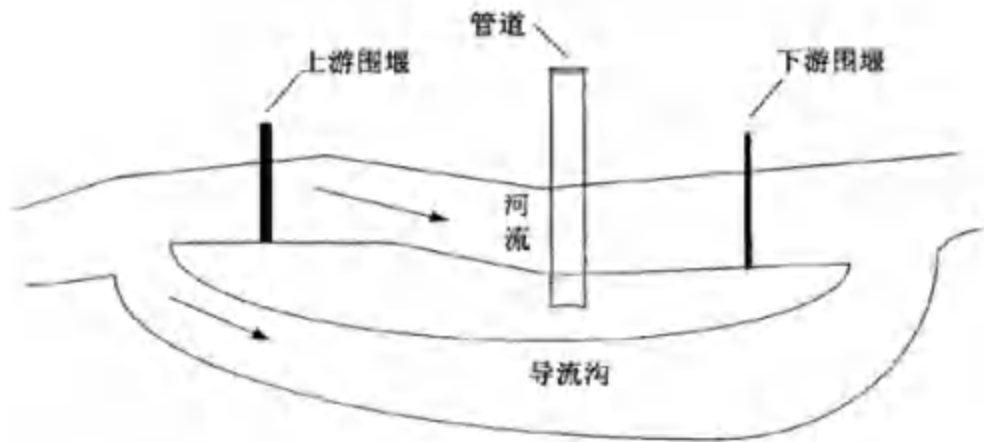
围堰导流开挖管沟穿越小型沟渠施工断面示意图
